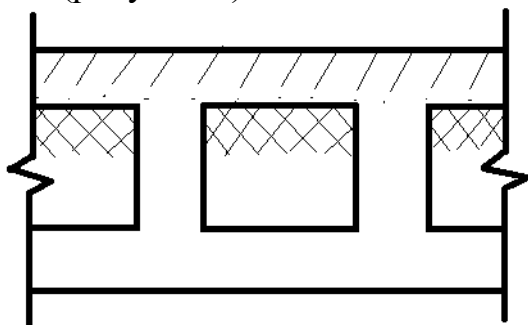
Конструкция кровли при утеплителе на мансардном этаже в разрезе
